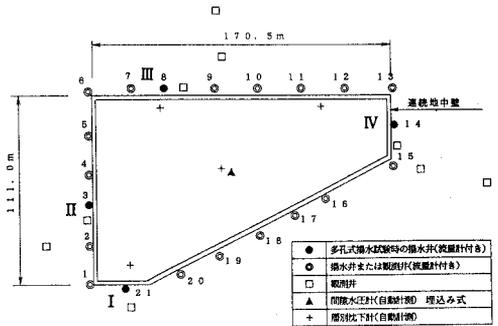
掘削平面, 揚水井, 観測井及び計測器配置図
